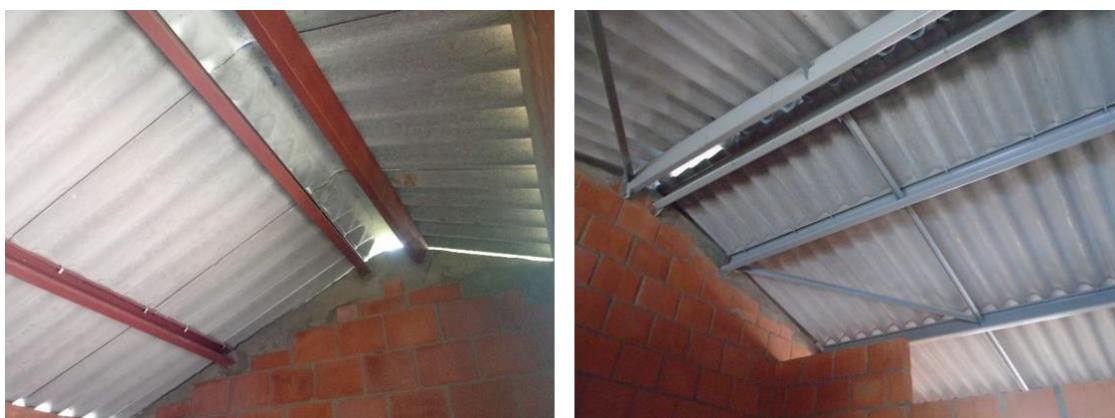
Cubierta de viviendas VIS. Fuente: empresa ITC avalúos.
